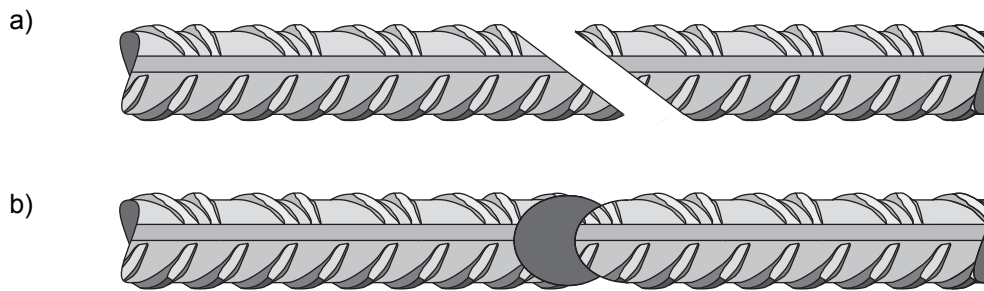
Draufsicht auf die schräg zur Längsachse des Bewehrungsstabes stehenden Bruchflächen mit sich (a) nicht überlappenden und (b) überlappenden Bruchflächen.
